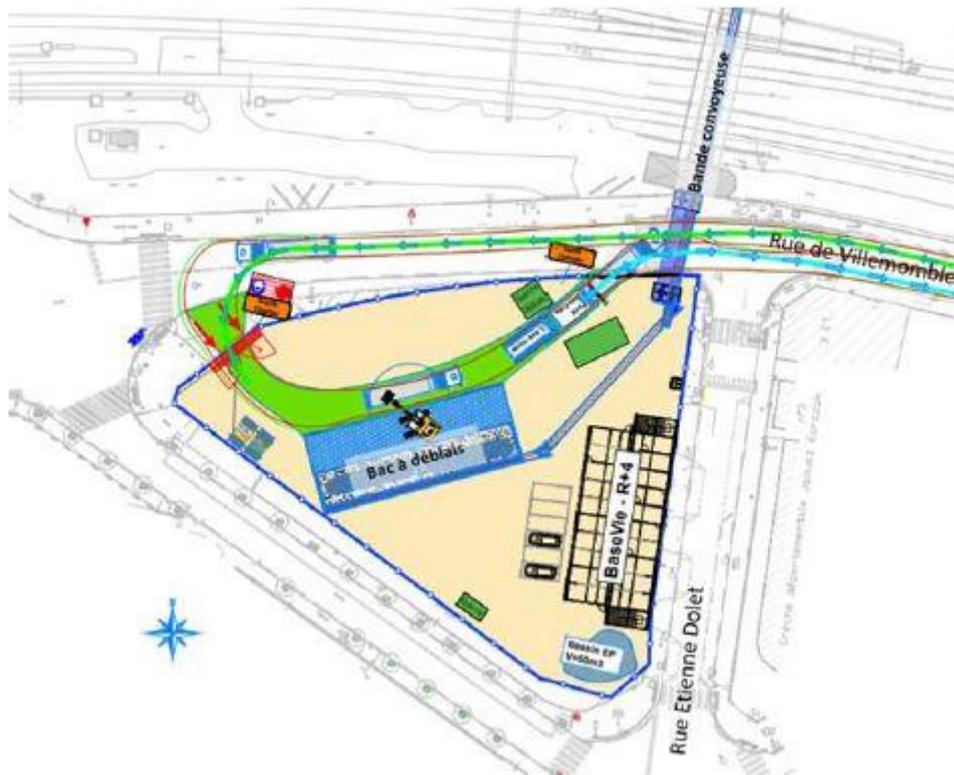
principes d'installation du chantier de l'emprise déportée (source : dossier)
